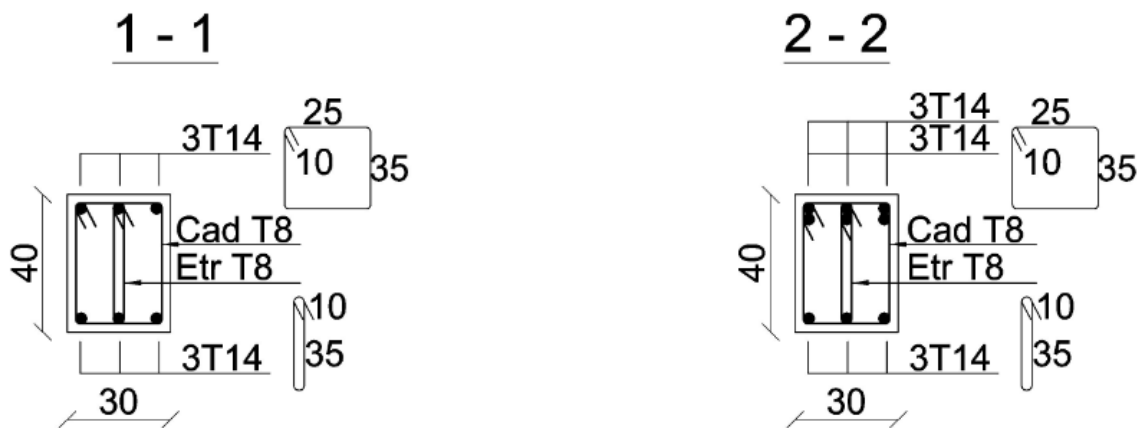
Schéma de ferrailage de poutre (30x40).
